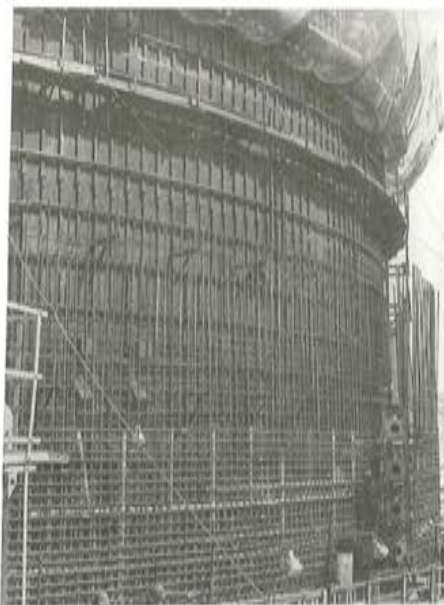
Detalle de la fotografía anterior – Trmpetas de los tendones y puesta a tierra de las armaduras.
